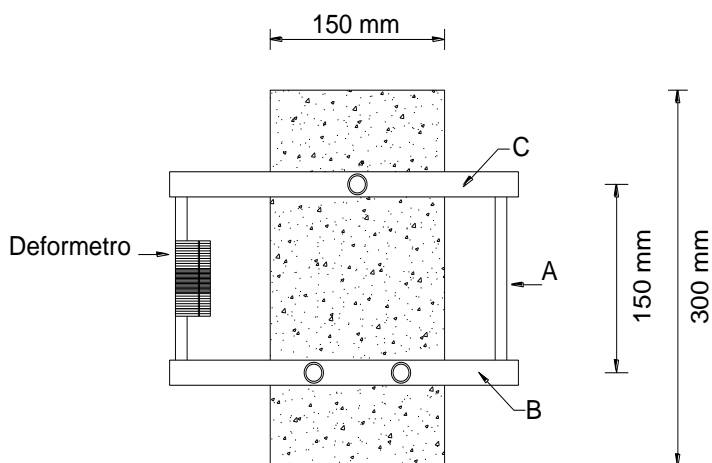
Molde de Cilindro de hormigón con el Compresómetro.
